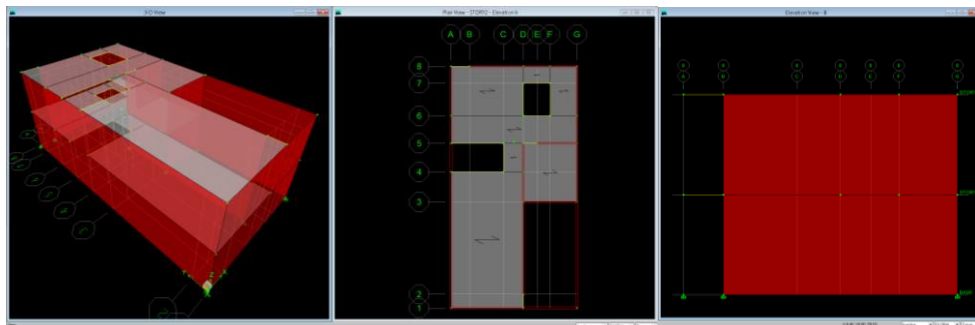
Vista en planta y elevación del modelamiento de la edificación 45
